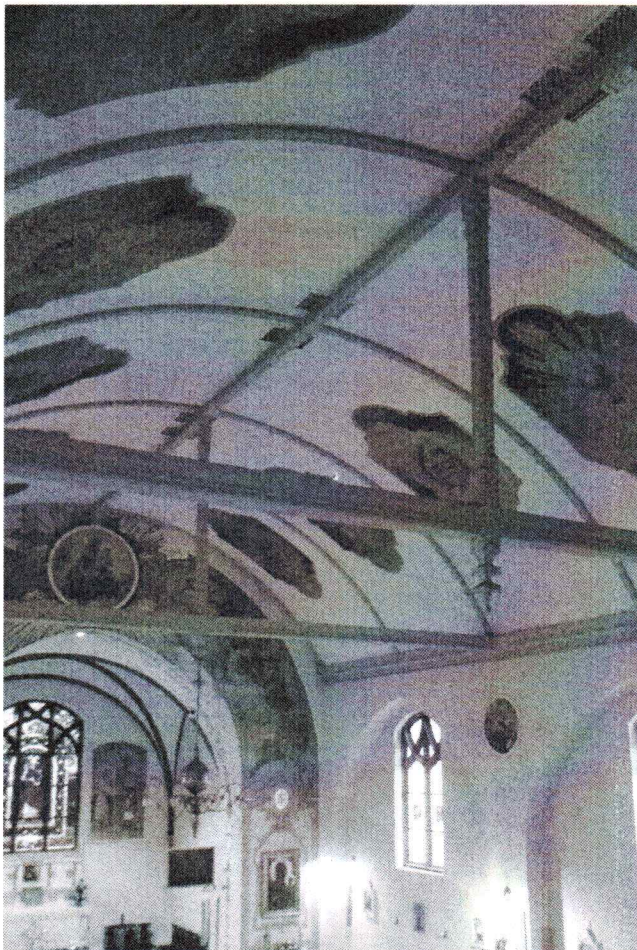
, 6 – Konstrukcja więźby dachowej - widok ogólny.
